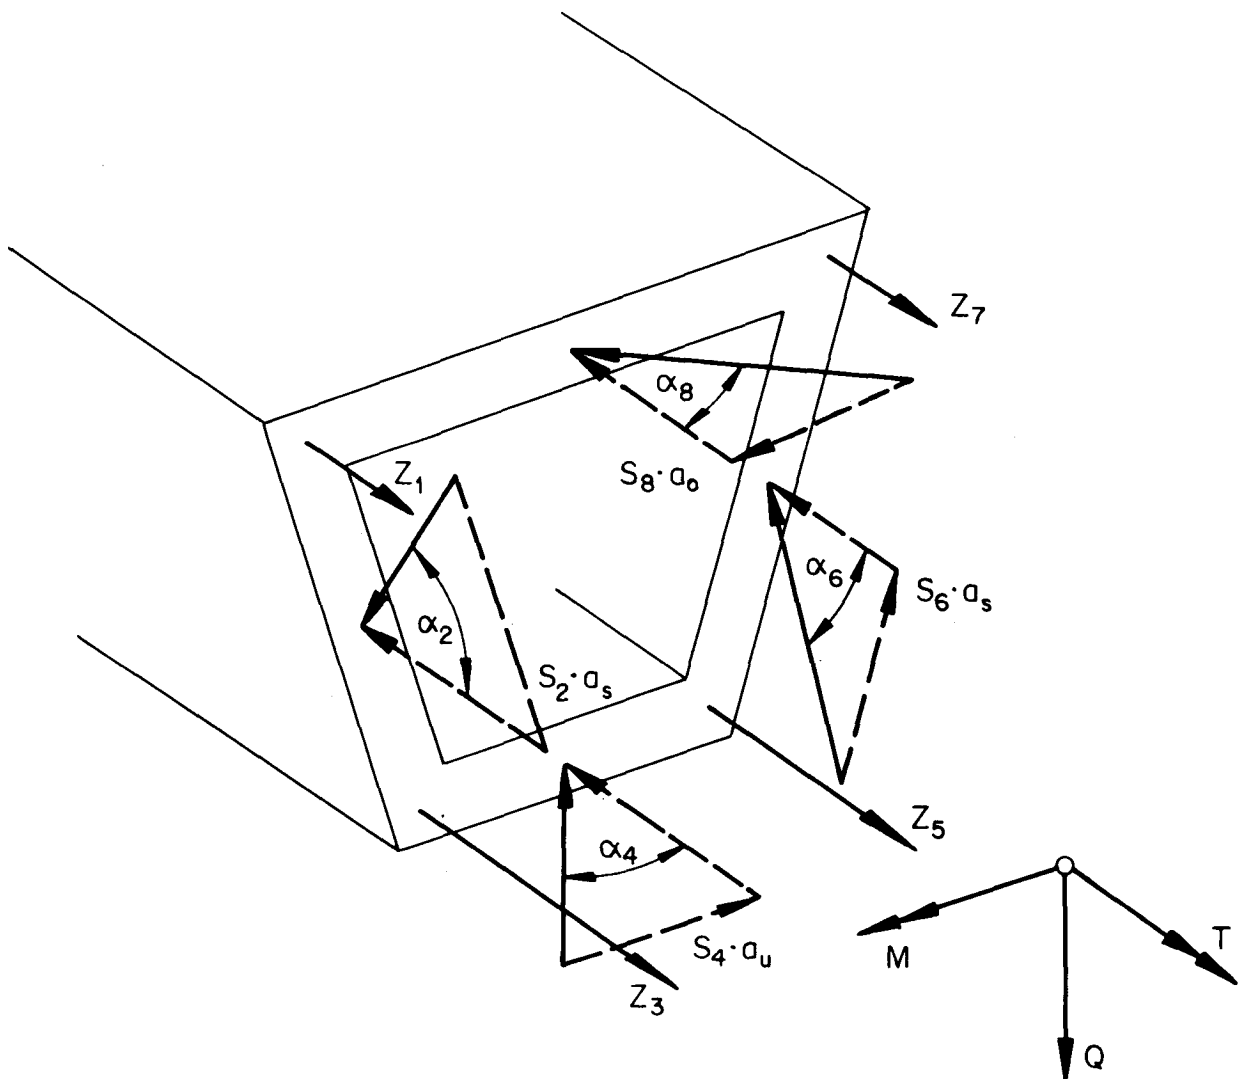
Schnittkräfte und innere Kräfte am Stahlbetontrapezquerschnitt
